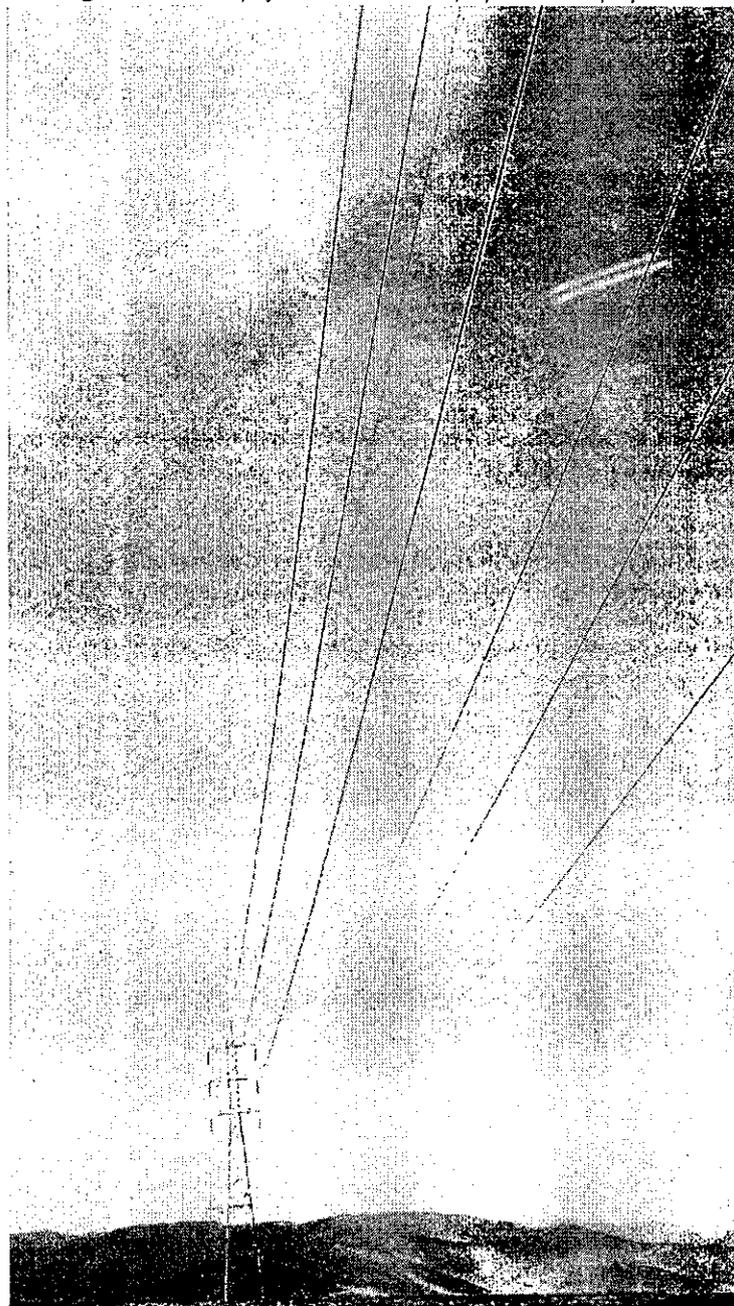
Vista del tramo Apoyo N°34- Apoyo N°35
